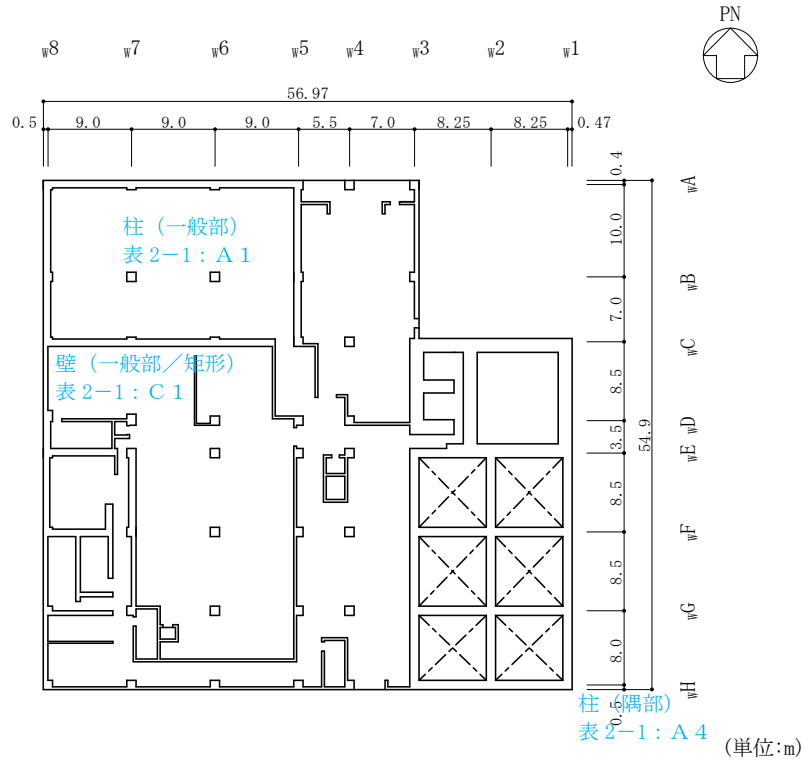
(7) 廃棄物処理建物の概略平面図 (EL 32.0m)
